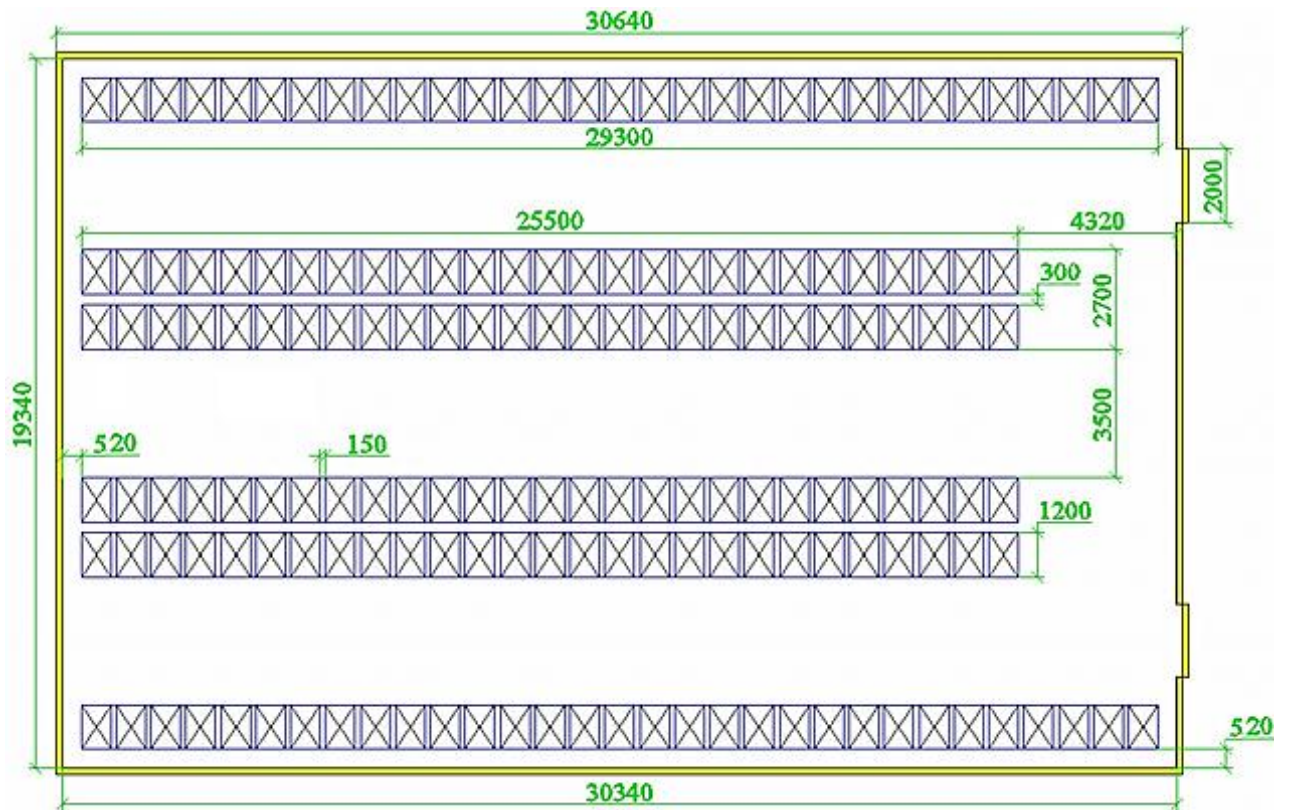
Planta da câmara frigorífica e distribuição das paletes no pavimento
